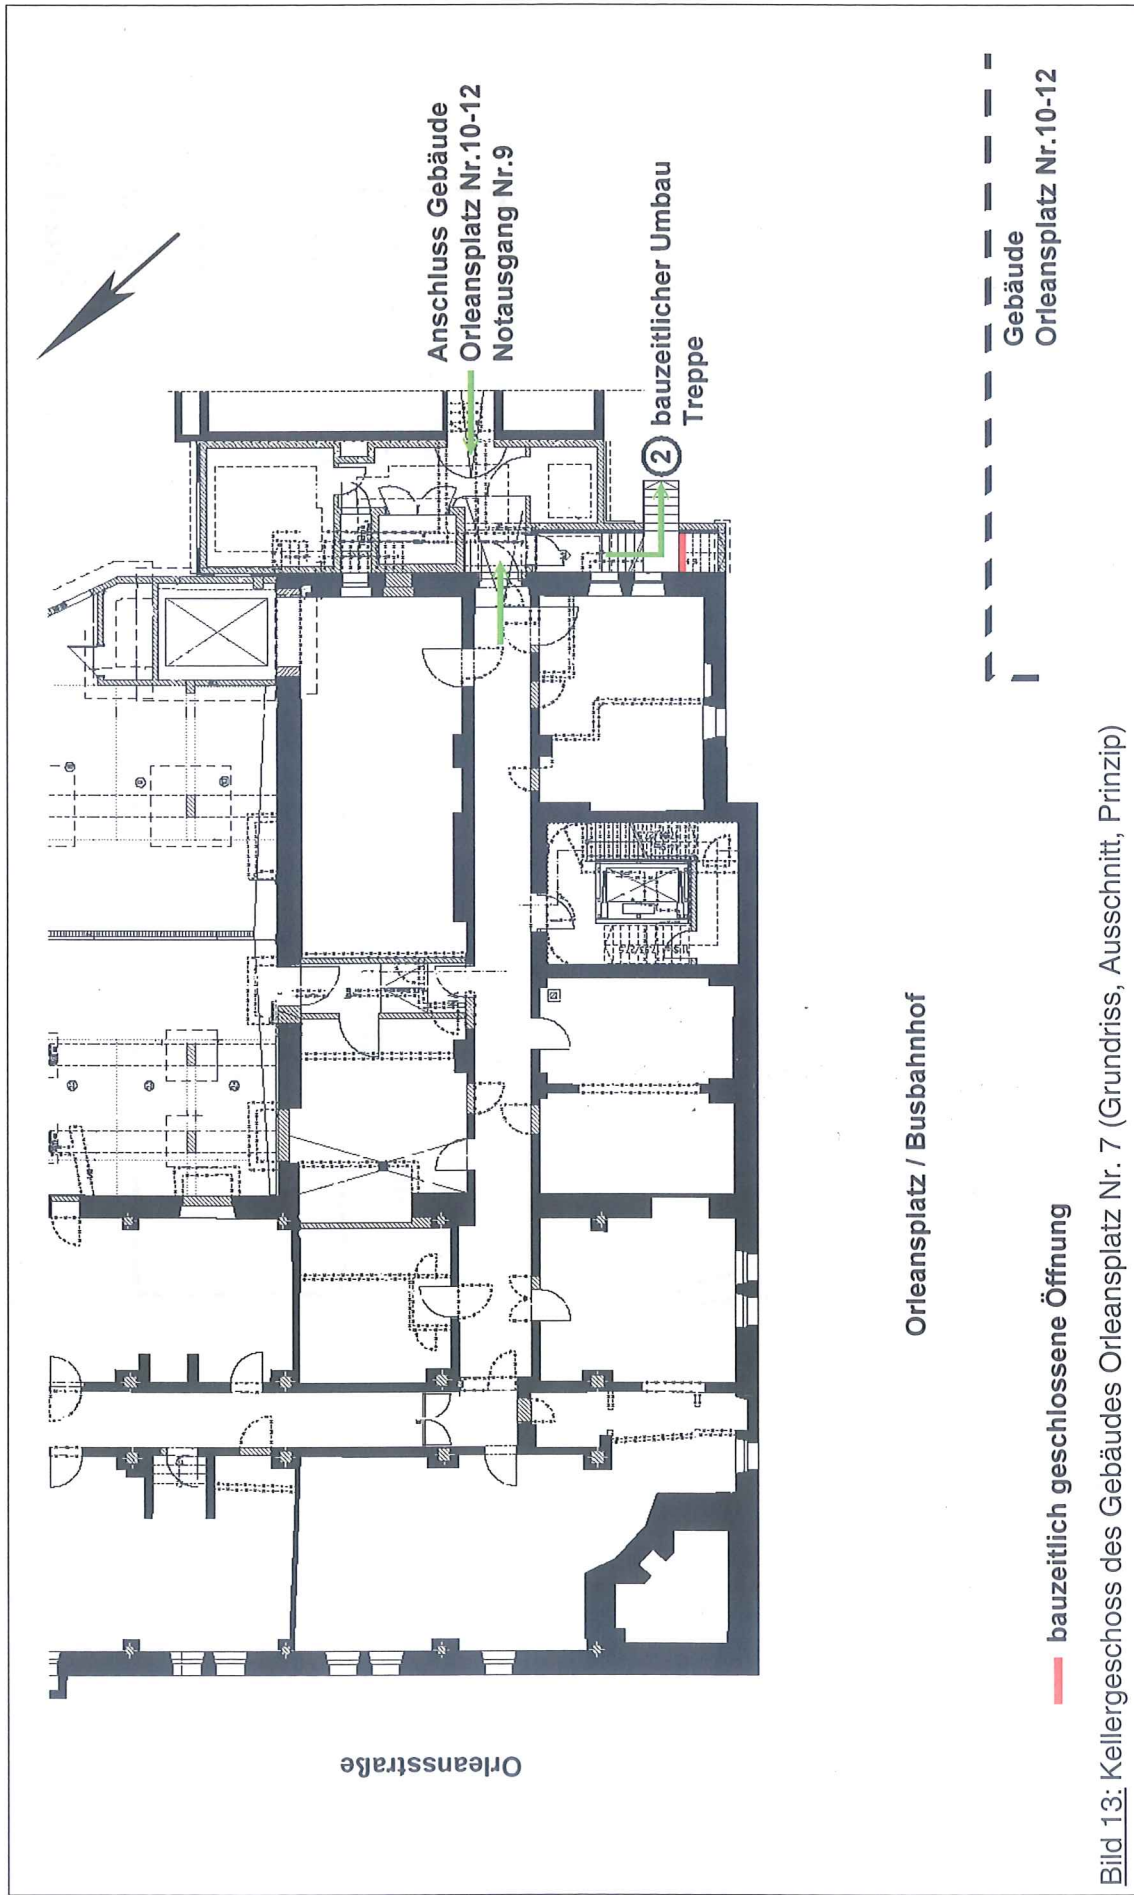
Kellergeschoss des Gebäudes Orleansplatz Nr. 7 (Grundriss, Ausschnitt, Prinzip)
